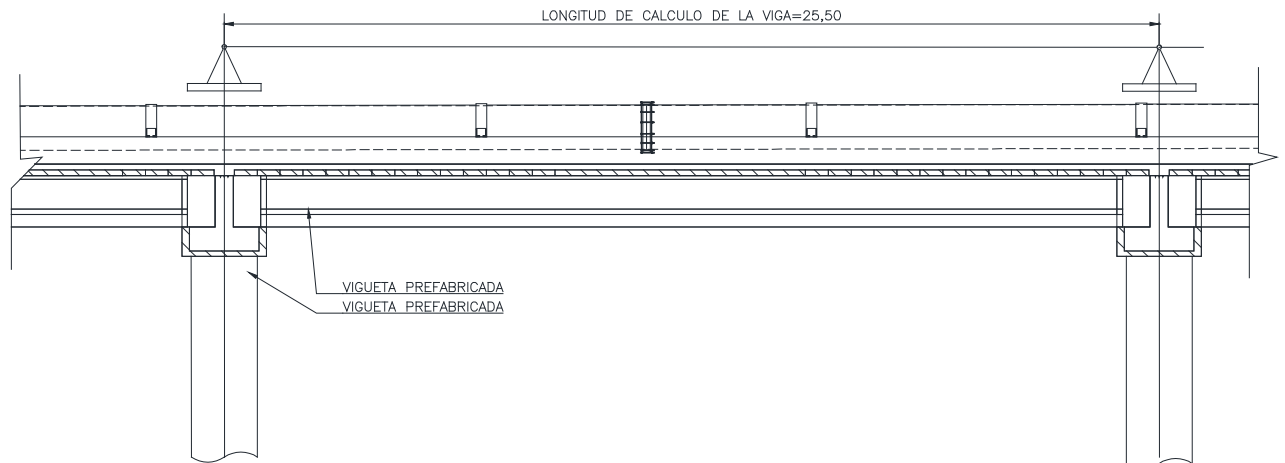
Esquema de cálculo de viga longitudinal (fuente: elaboración propia)
